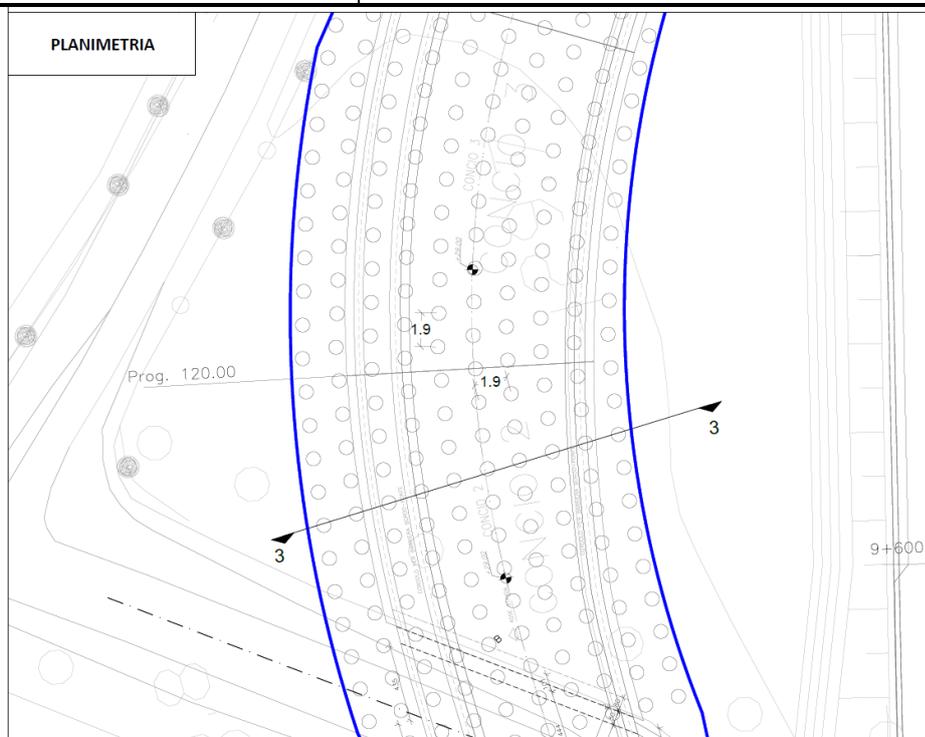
Sezione rappresentativa tratta IV03 – scatolare - planimetria
